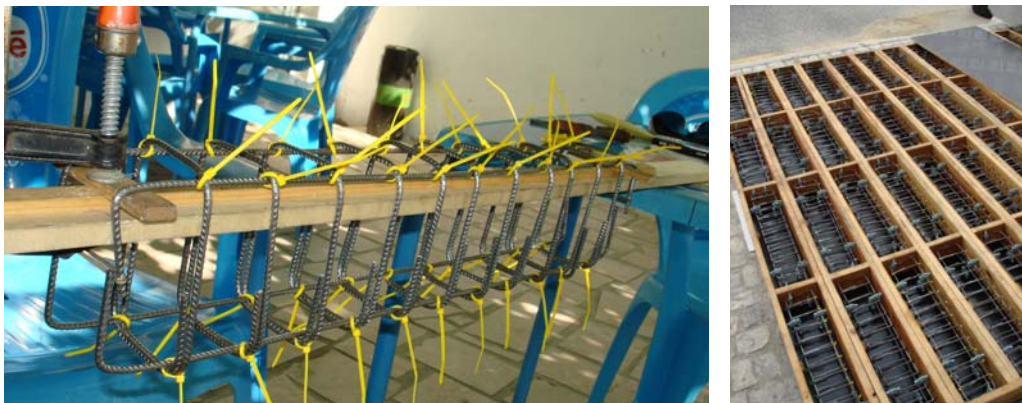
Armadura e cofragem utilizada na execução das vigas de secção rectangular.
